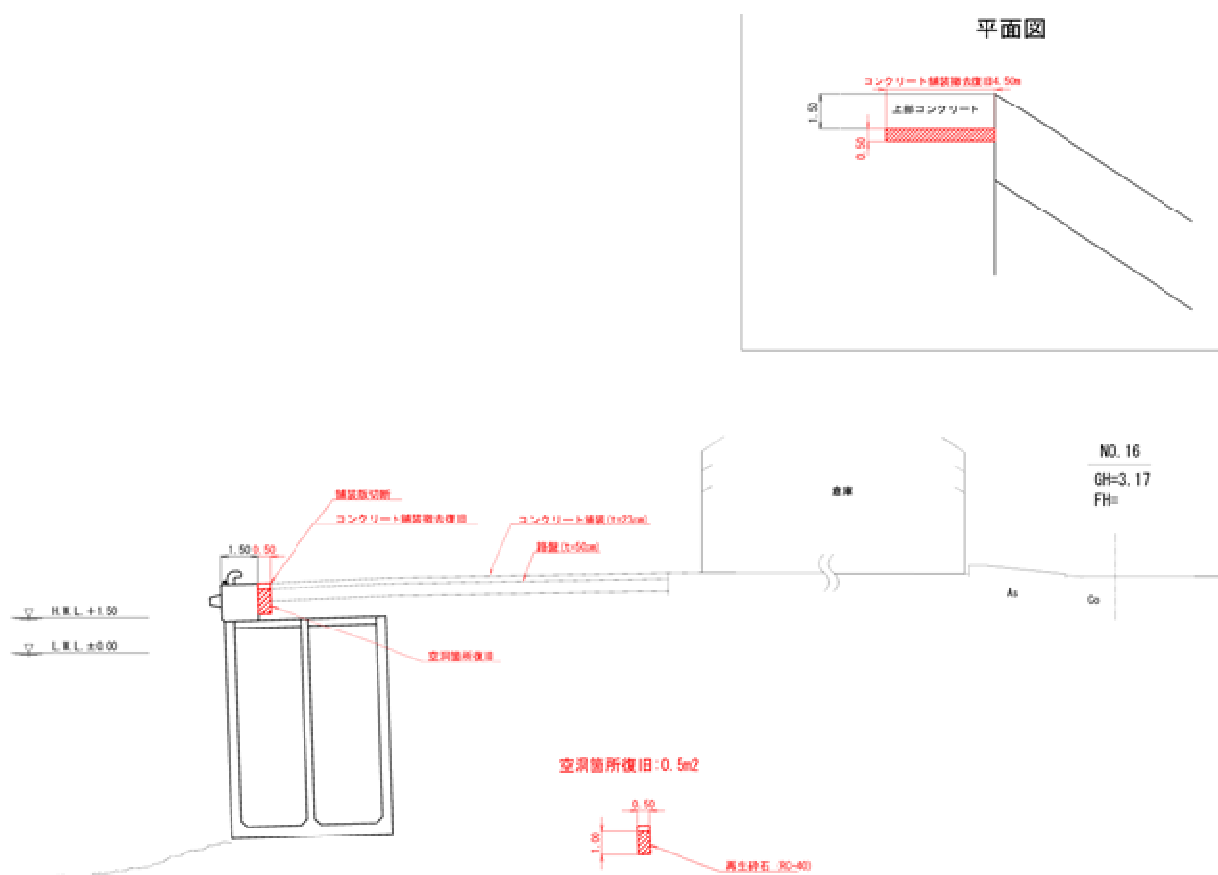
No.3 日立港区\_第1ふ頭地区 1-C 岸壁 (-7.5m) の断面図① (復旧後)
